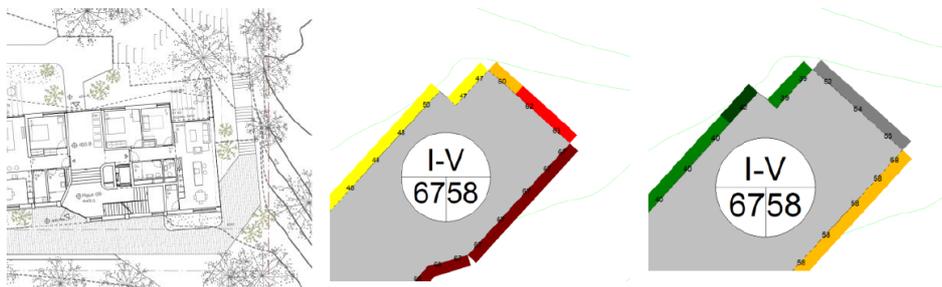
nordöstliche Stirnseite des Riegels entlang der Schaffhauserstrasse; links Ausschnitt Grundriss Vorprojekt mit stirnseitig verlängerter Fassade, Mitte Gebäudelärmkarte Tag (maximale Fassadenbelastung), rechts Gebäudelärmkarte Nacht (maximale Fassadenbelastung)
